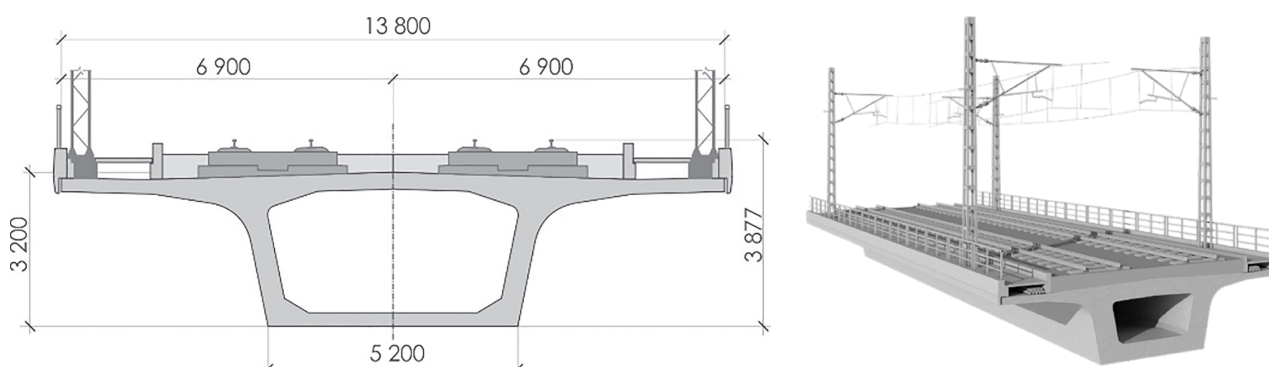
Поперечное сечение пролетного строения полной длиной 34,2 м из предварительно напряженного железобетона (расчетный пролет 33,1 м)
